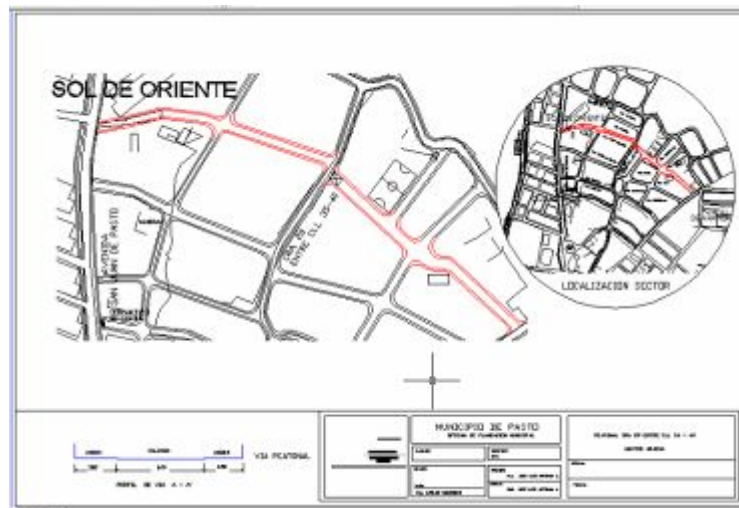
Planta y sección transversal calle 39 entre Av. Inesco y carrera 26
